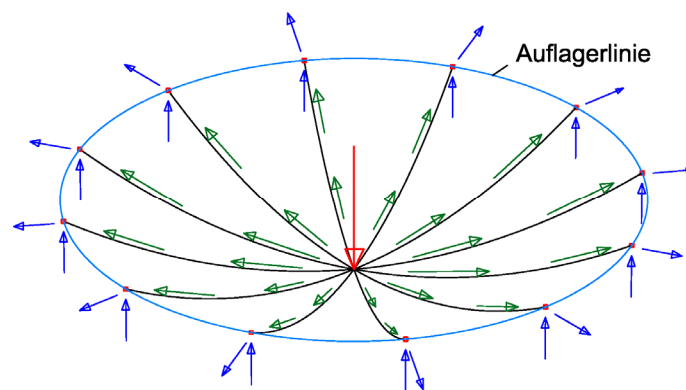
Lastabtrag bei kreisrundem Grundriss (Isometrie)
